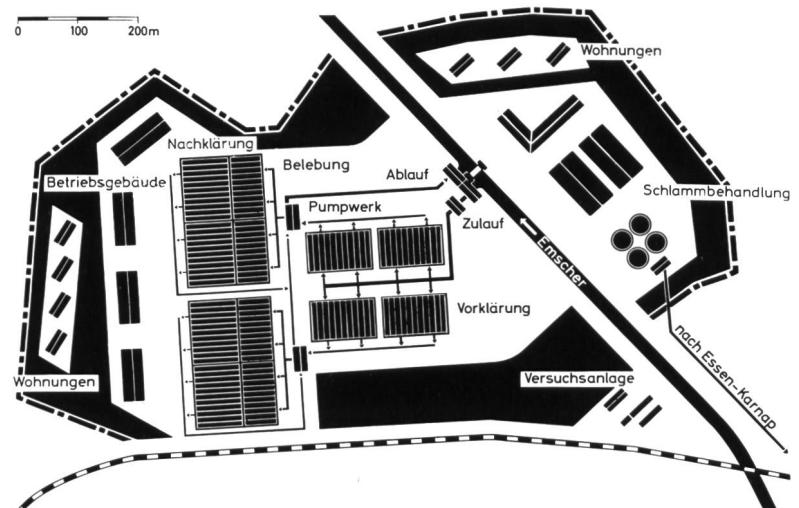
Lageplan des Klärwerks Emschermündung (Entwurf)
